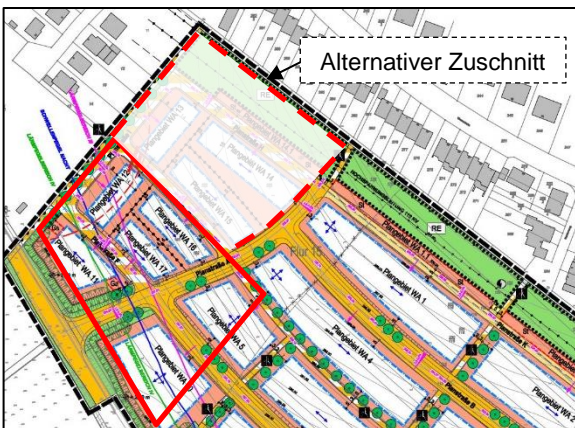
Ausschnitt Bebauungsplan „Wohnpark/Farnwiese“ (ohne Maßstab, genordet)
